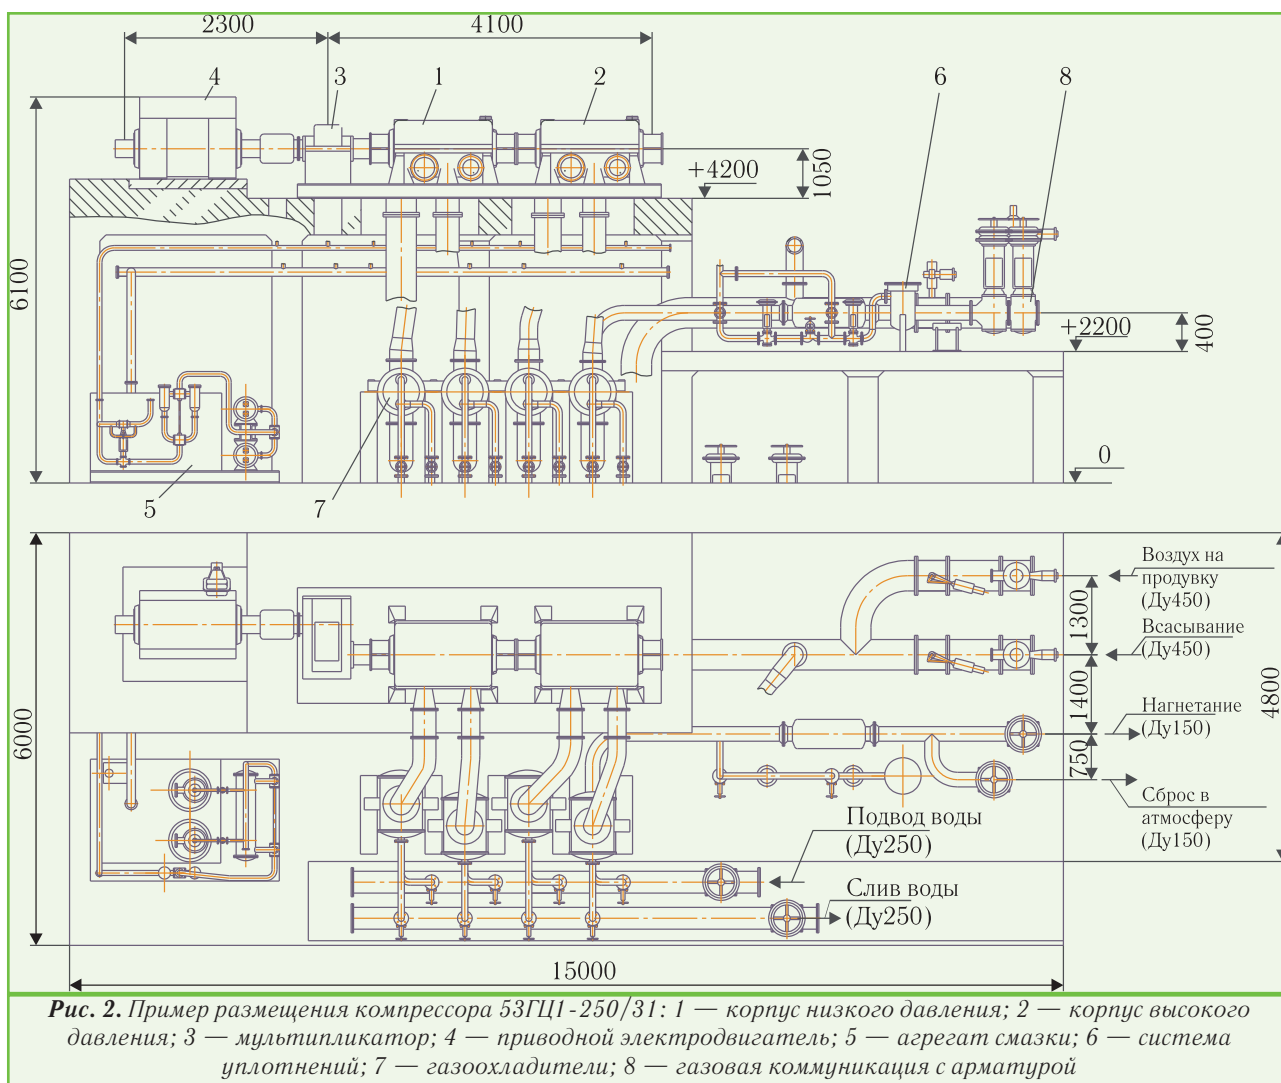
Пример размещения компрессора 53ГЦ1 - 250/31: 1 — корпус низкого давления; 2 — корпус высокого давления; 3 — мультипликатор; 4 — приводной электродвигатель; 5 — агрегат смазки; 6 — система уплотнений; 7 — газоохладители; 8 — газовая коммуникация с арматурой
